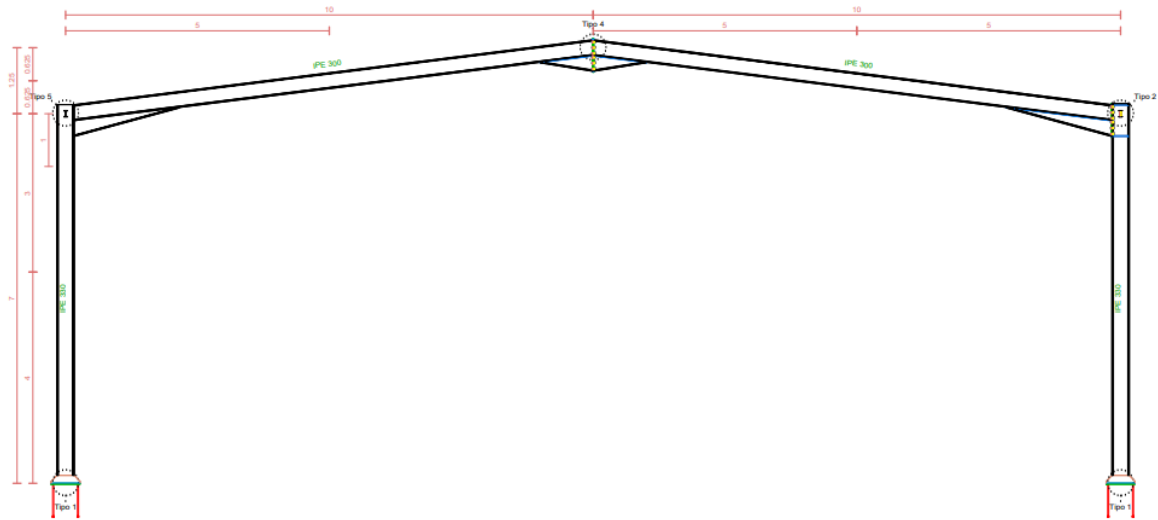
PÓRTICO INTERMEDIO – AUTOCAD
